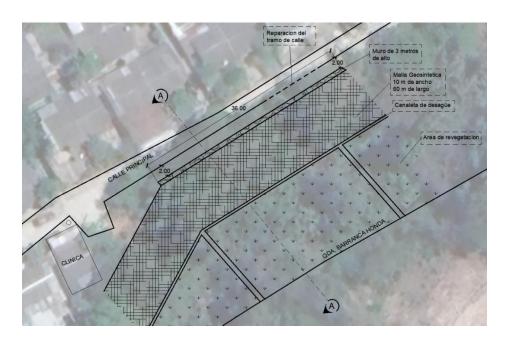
Vista en planta de la distribución de las obras en el terreno (mayo, 2021).
